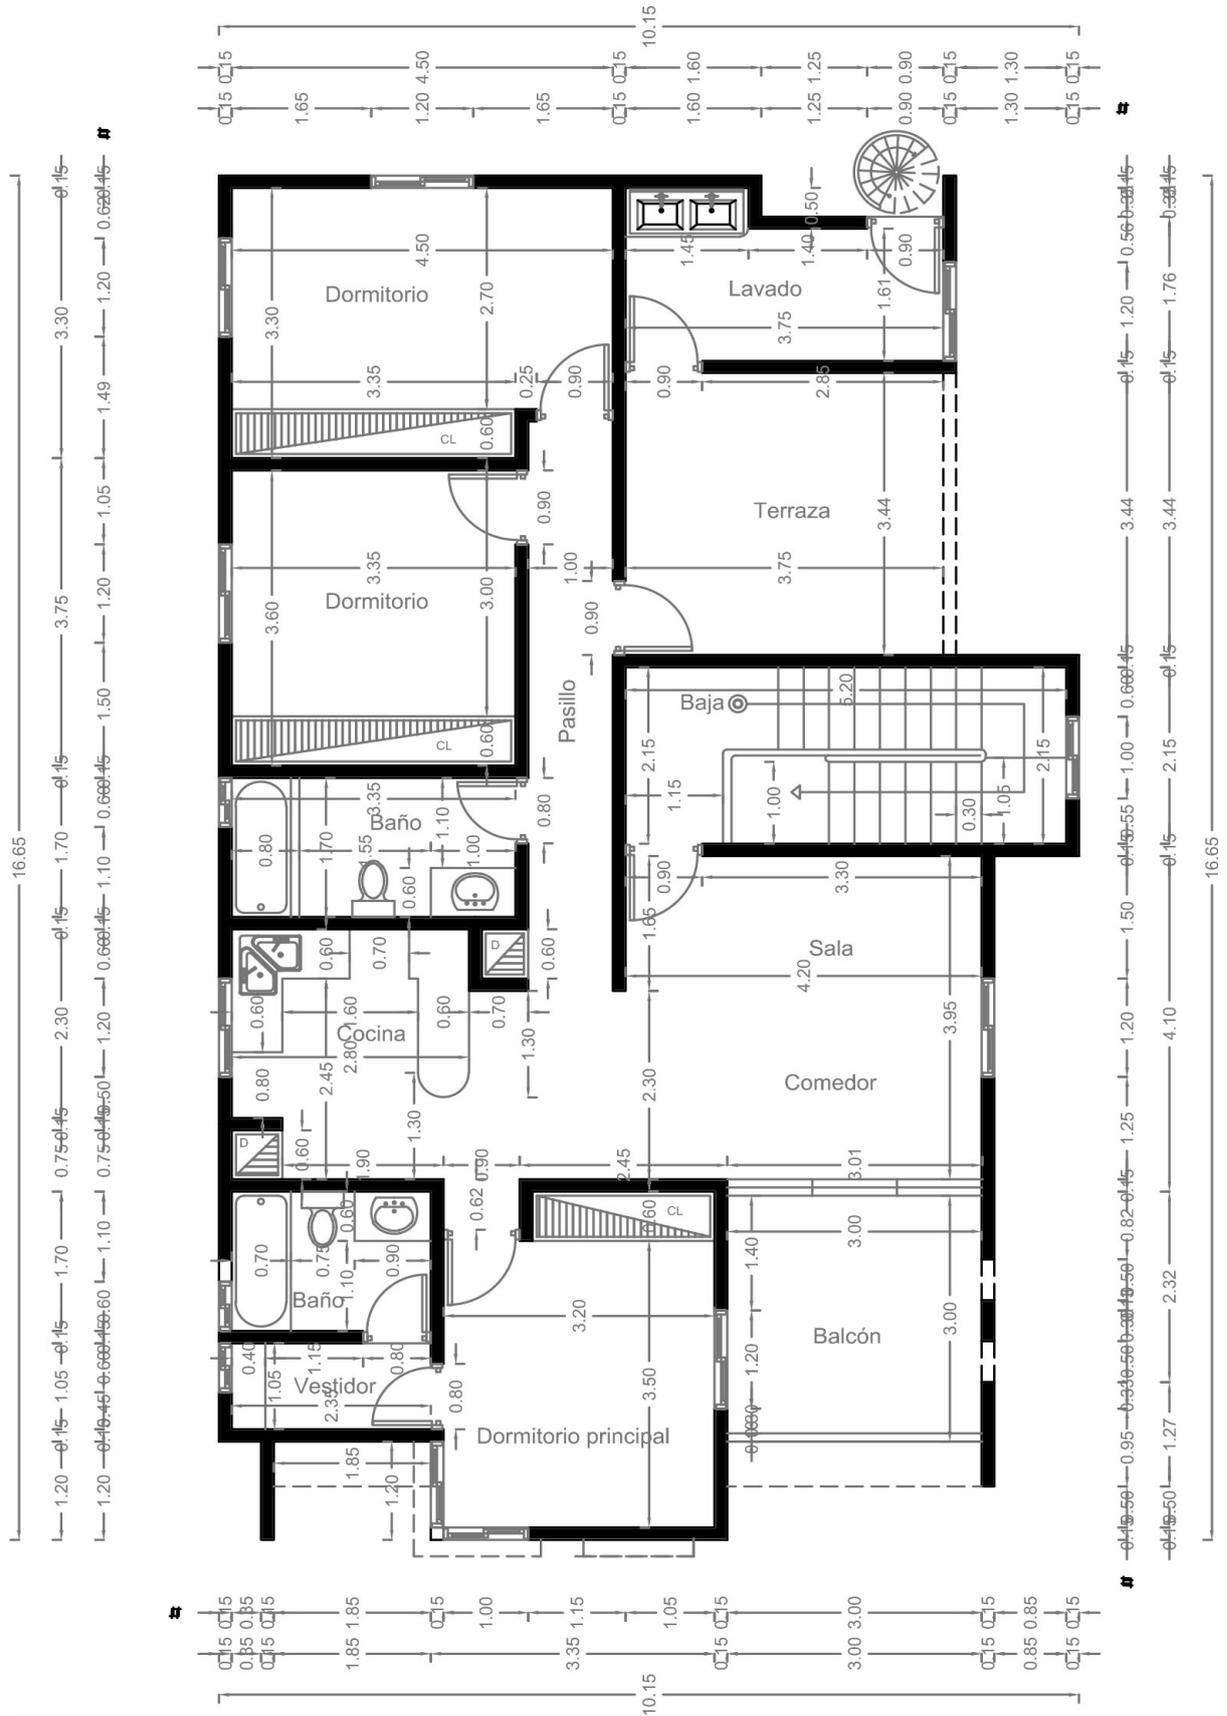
PLANTA ARQ. DIMENSIONADA (PLANTA PRIMERA)
